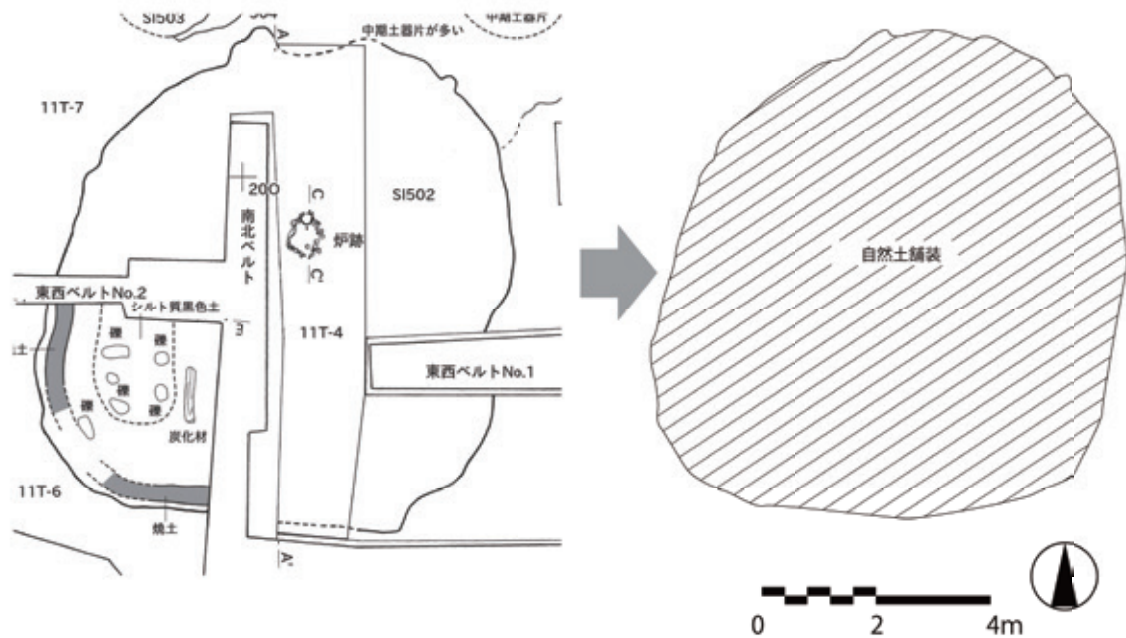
竪穴住居の平面表示 整備イメージ（平面形状のみ表示）
